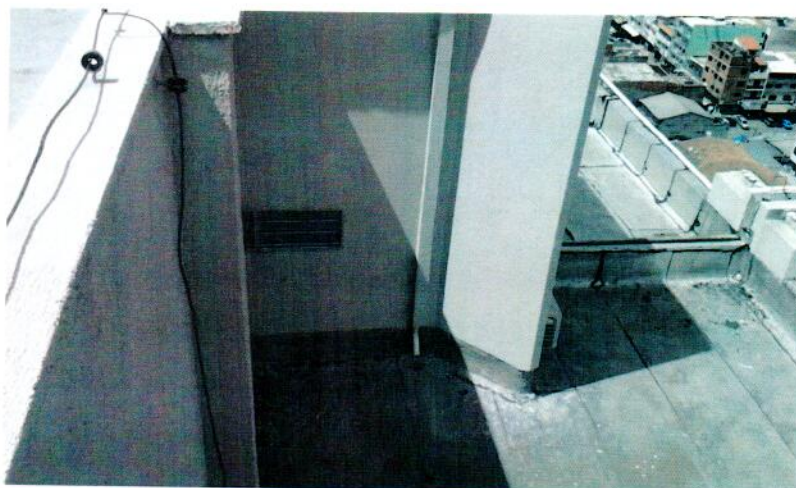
Necessidade de limpeza na laje e arremate de impermeabilização em parede (Bloco C)
